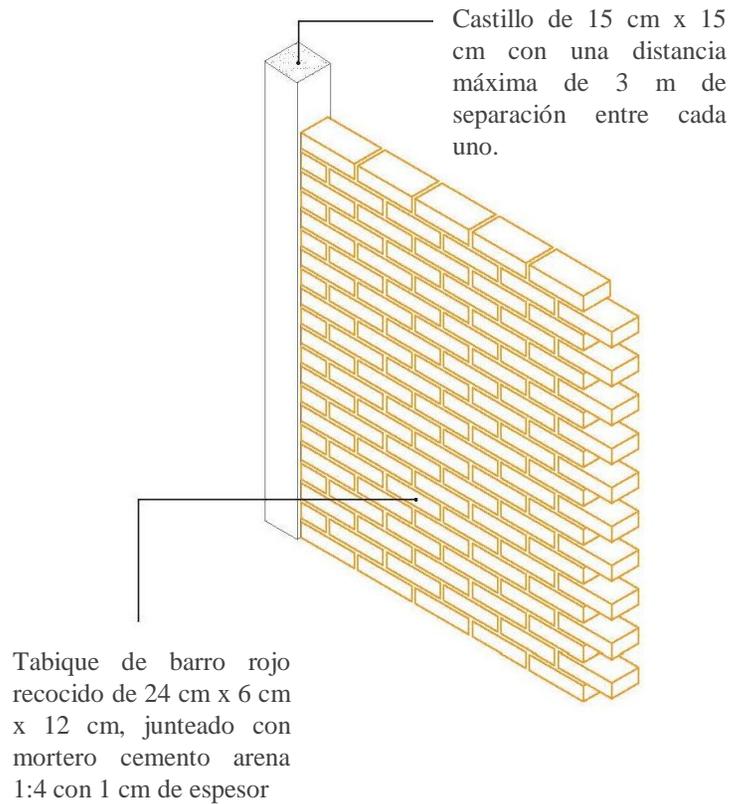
Albañilerías en planta sótano. *Amador, E. (2020).
